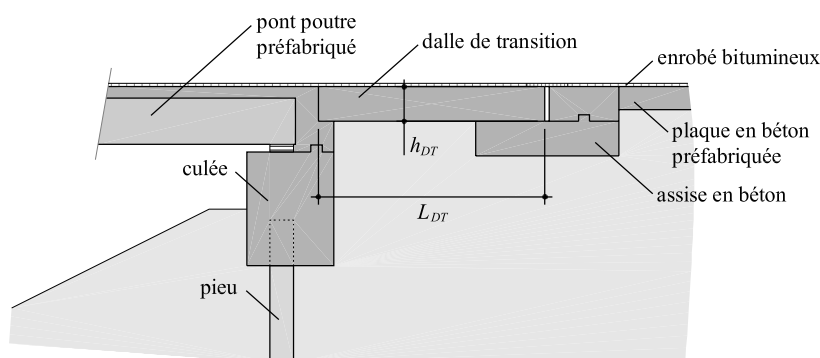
Détail standard d'une dalle de transition d'un pont intégral au New Jersey / USA [New Jersey DOT 2002]
